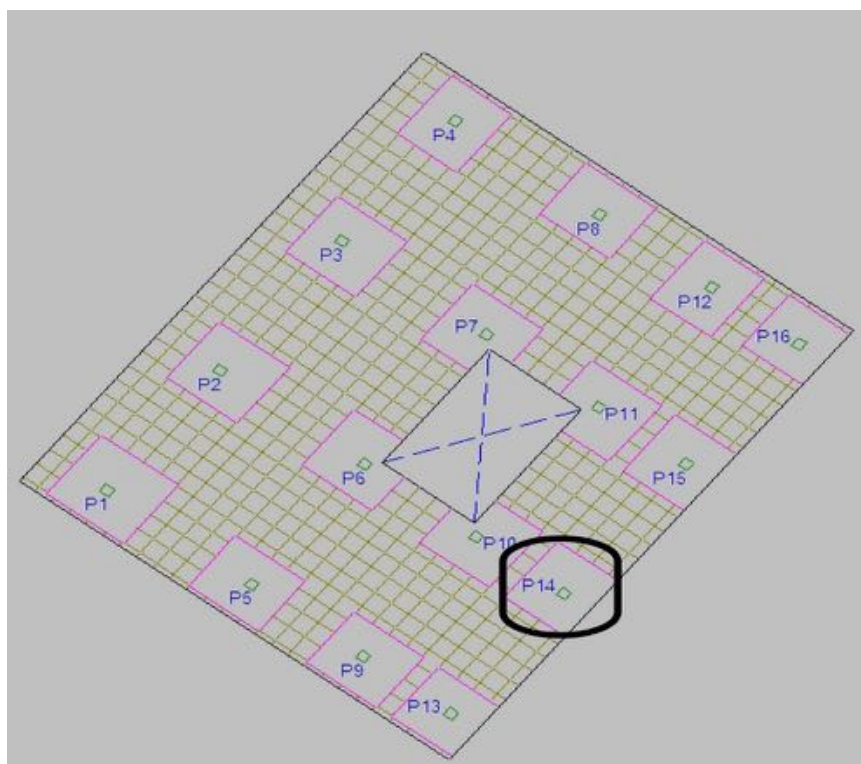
Recorte en planta en Cype con ábacos de refuerzo.
